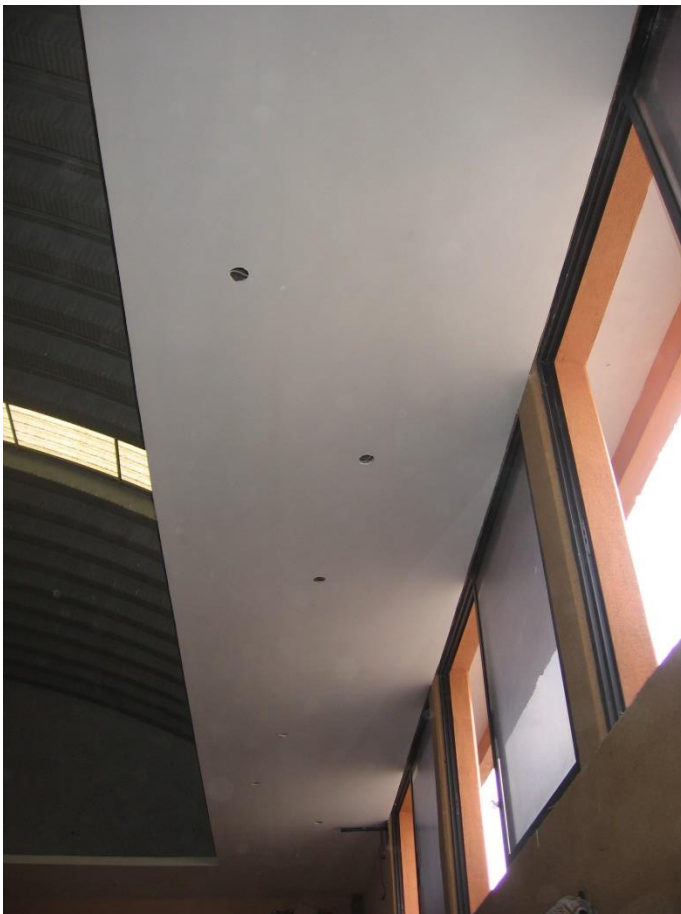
Proceso de obra, instalación de luminarias en salón secundario. Autoría propia
